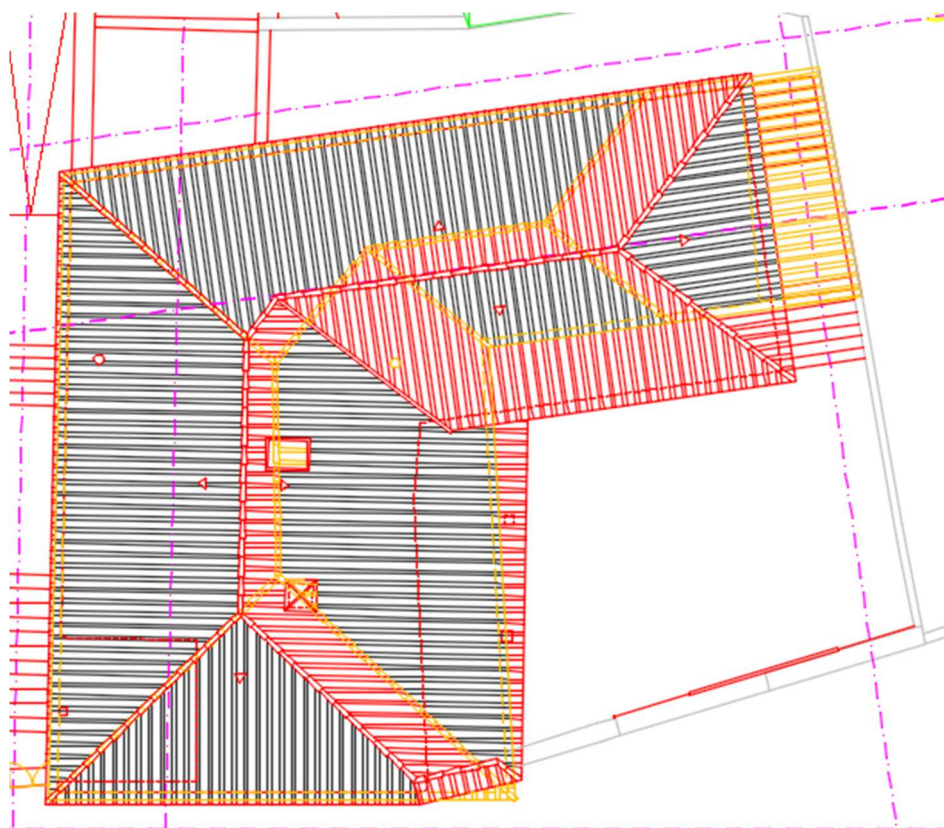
Planta de arquitetura da cobertura - vermelhos e amarelos (planta sem escala).
